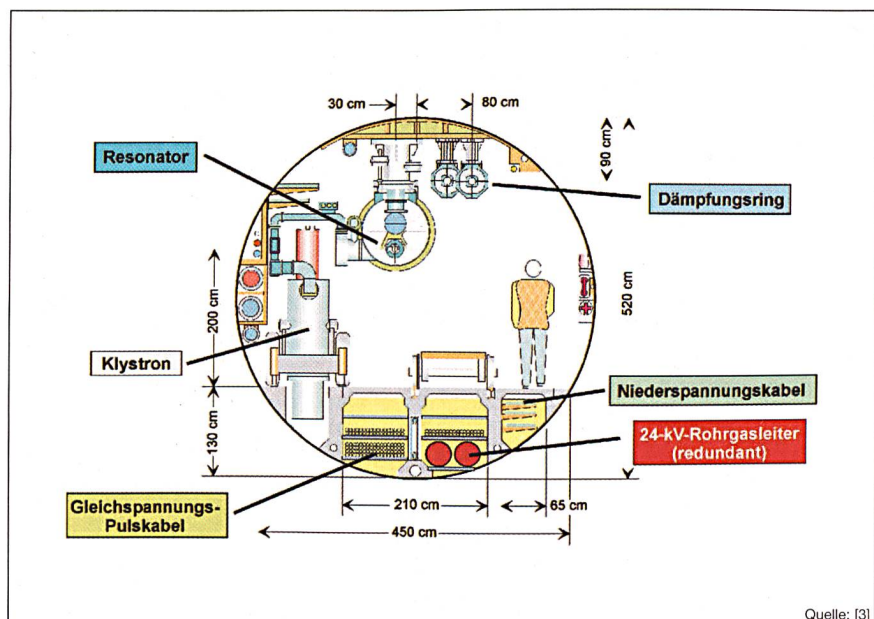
Tunnelquerschnitt des geplanten Linearbeschleunigers Tesla
